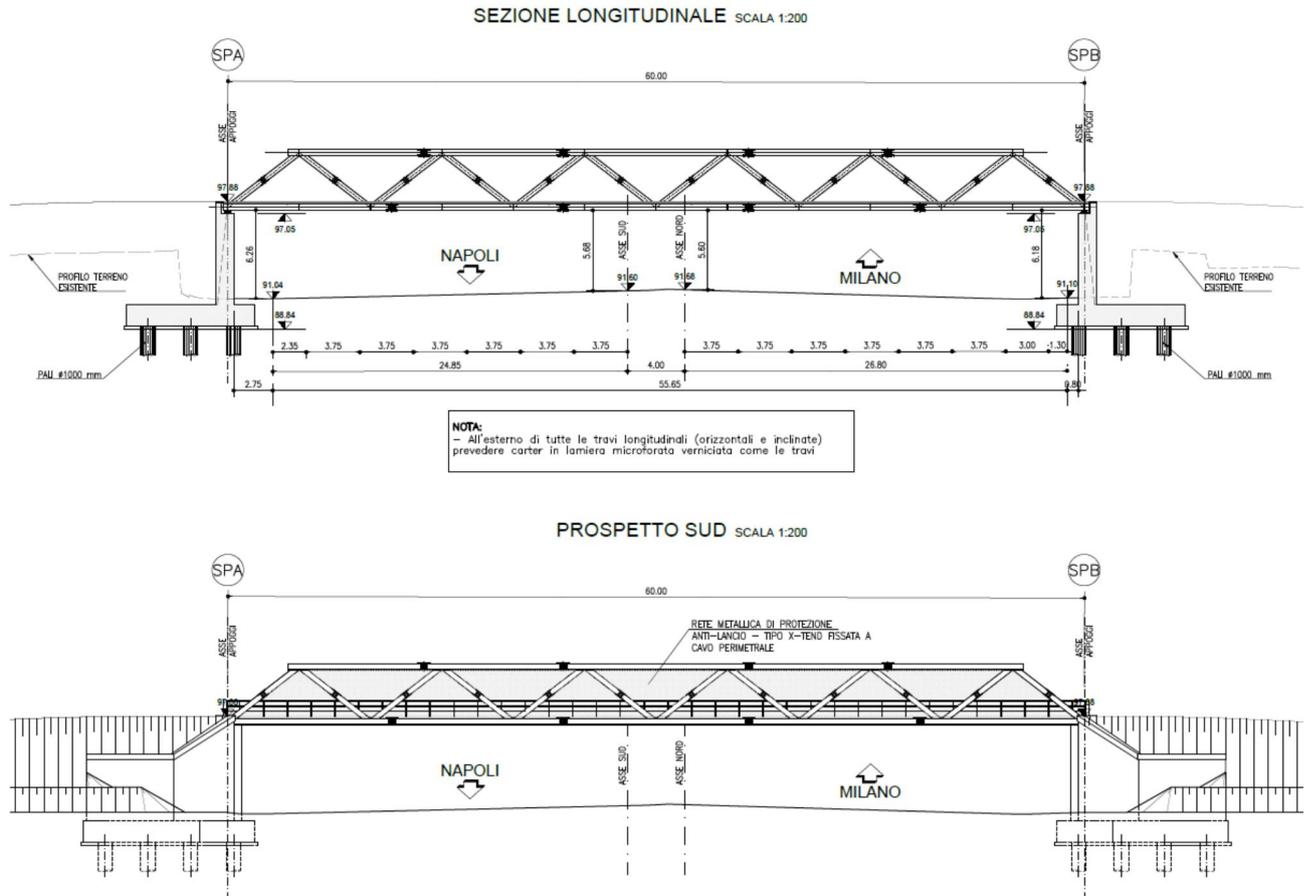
Progetto: sezione longitudinale e prospetto passerella
